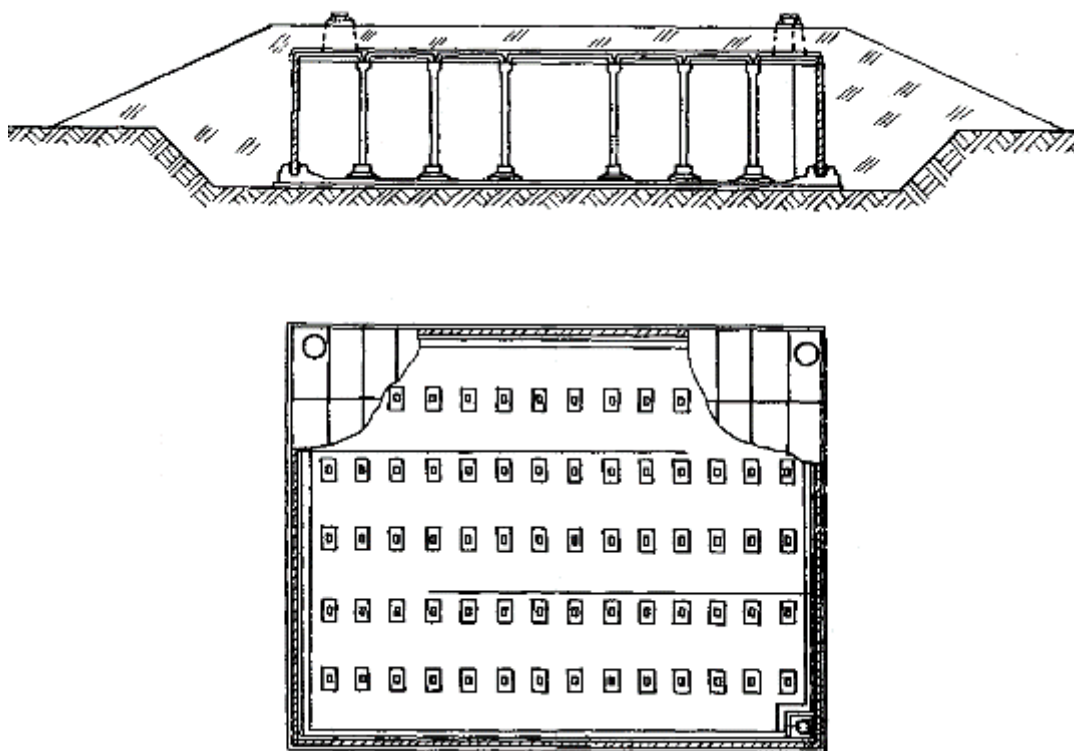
Эскиз общего вида резервуара ЖБР-10000
